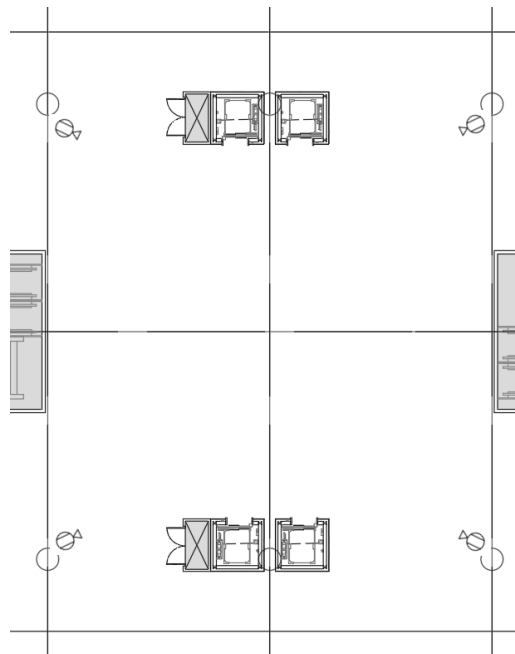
Sistema CCTV ascensores Planta 1 Estación típica
